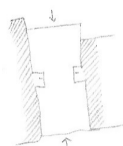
Boceto en planta de la geometría de la construcción situada en la Rúa Camilo Veiga, nº 42 (autoría propia).
